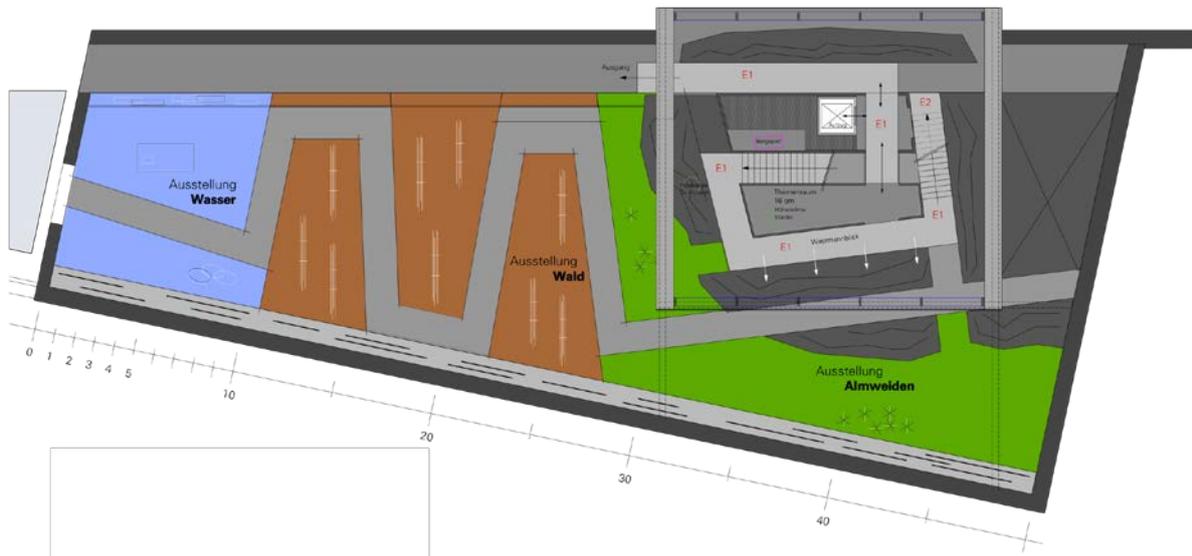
Grundriss der Ausstellung „Vertikale Wildnis“ mit farblicher Markierung der vier Lebensräume (Atelier Brückner, Stuttgart)
